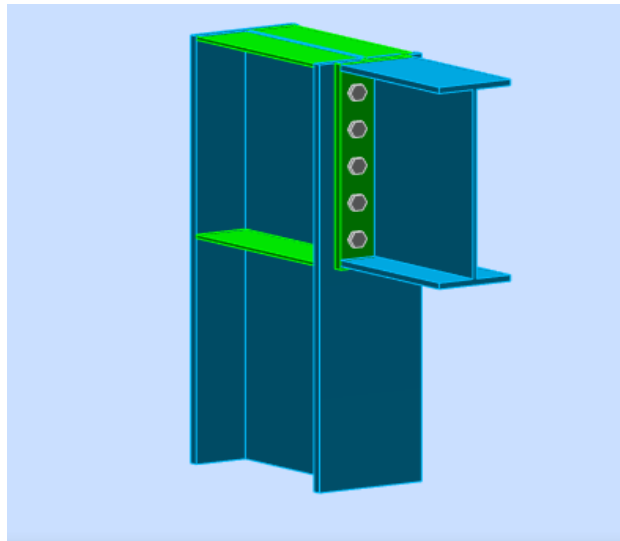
5 : Assemblage poteau-poutre IPE550- HEA550
